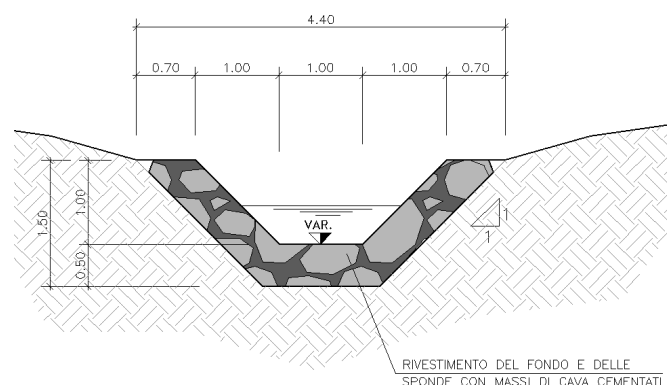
Sistemazione alveo Rio 1 – Sezione tipo 1
